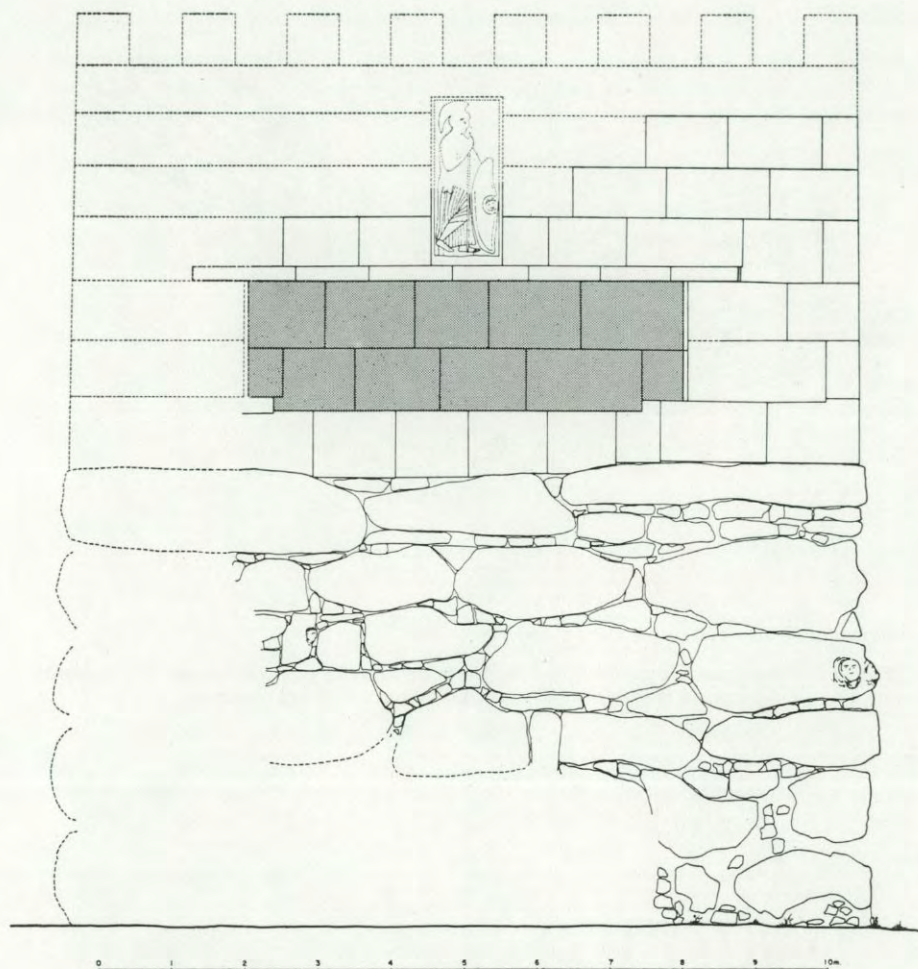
Tarragona, muralla. Torre de Minerva, fachada Este.
